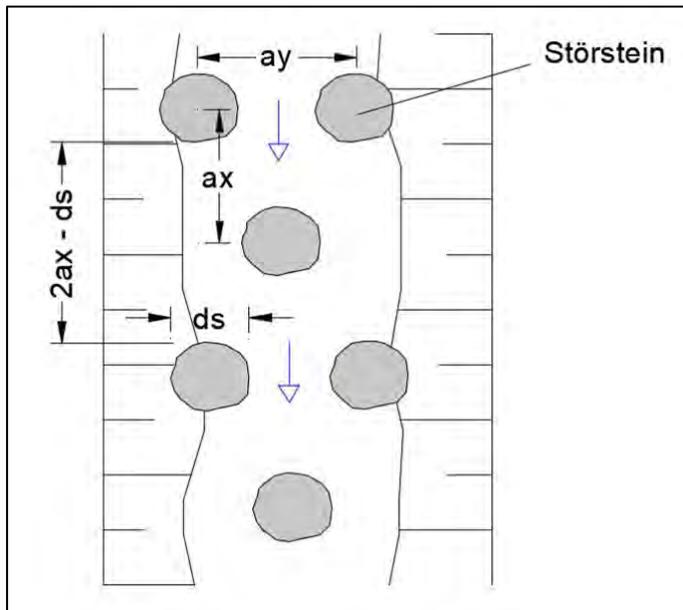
Prinzipdarstellung Raugerinne mit Störsteinen im Grundriss (nach DWA); für Begriffserklärung vgl. Tabelle 3-22
